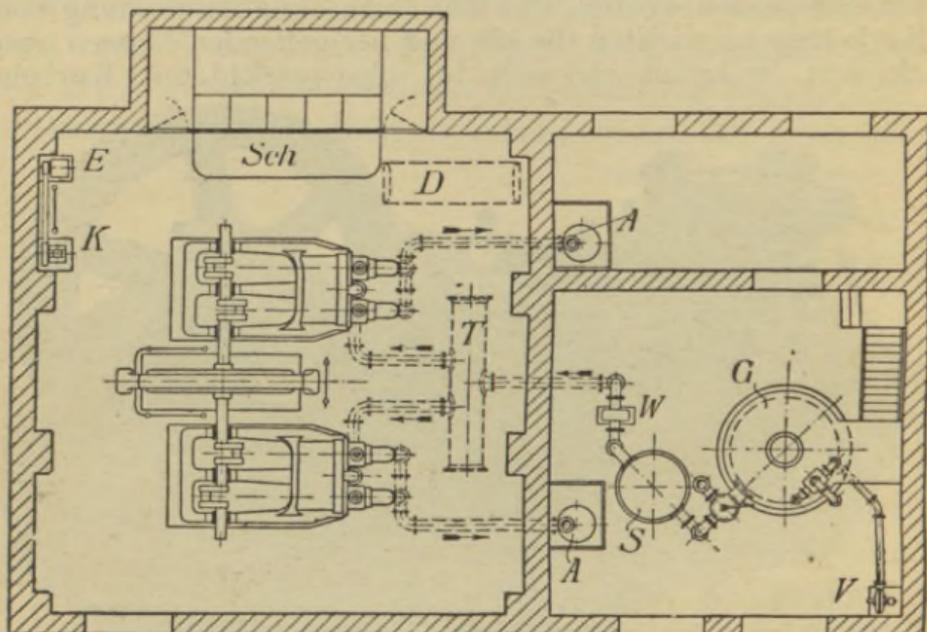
Grundrißplan einer Doppelmotorzwilling-Anlage der Gasmotorenfabrik Deutz (Sauggasanlage).
